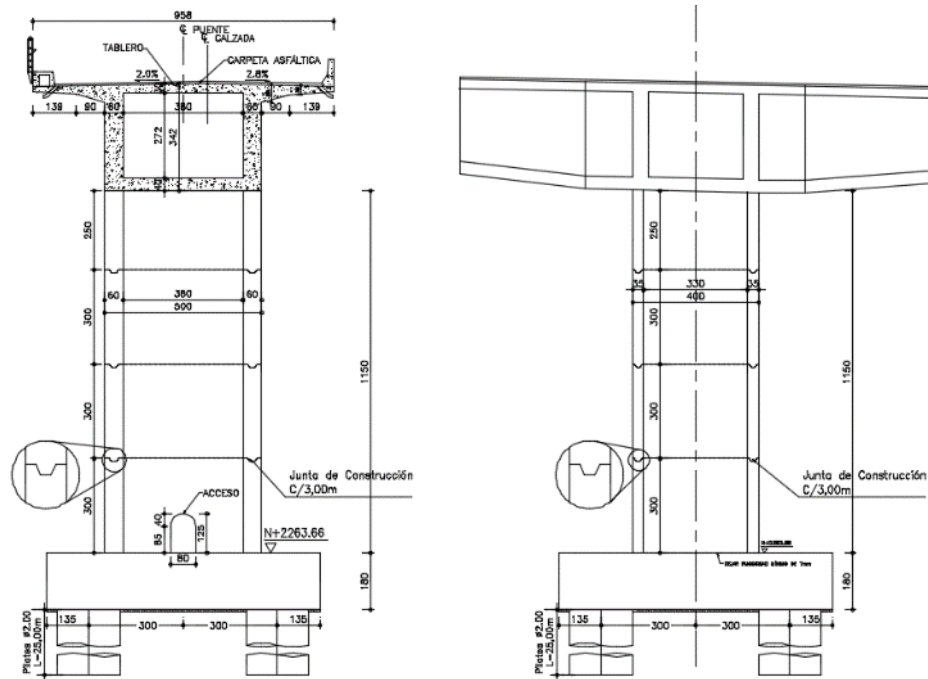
Geometría apoyo eje 3 – Puente Bermúdez
